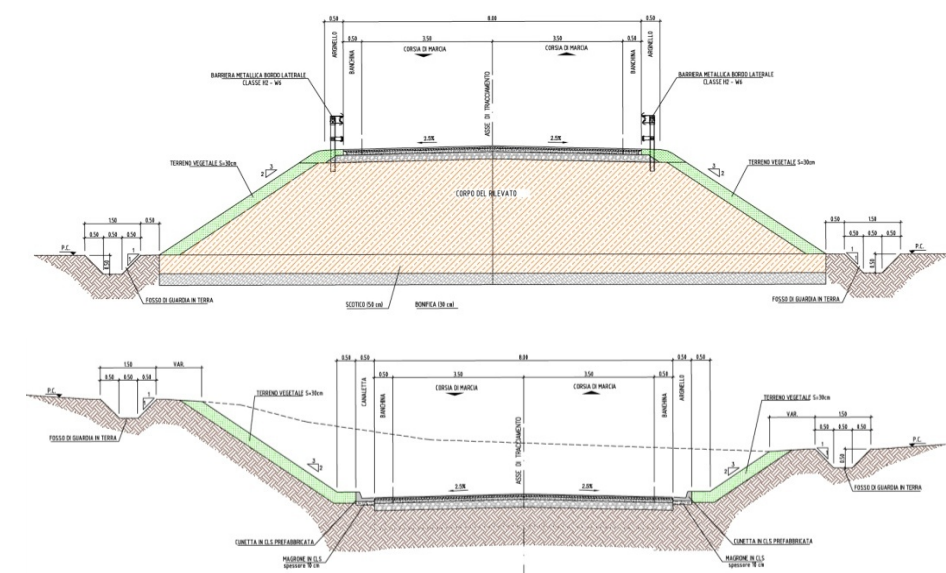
Tracciato stradale - Sezione tipo in rilevato ed in trincea
